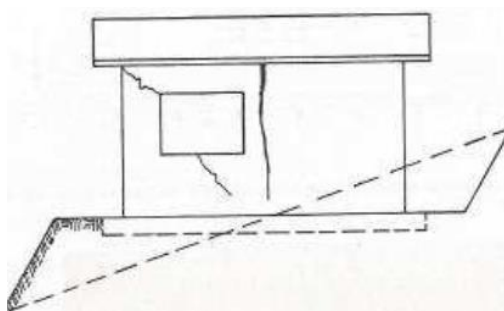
Fissuração acompanhando um pilar
